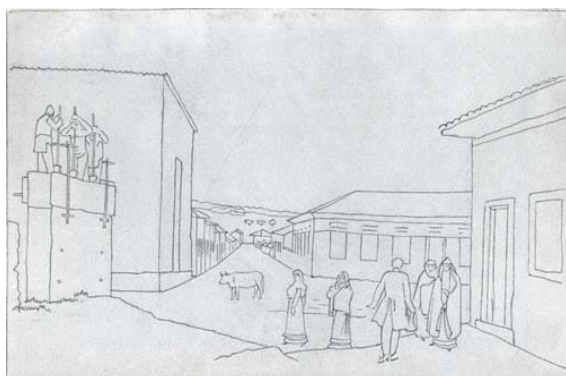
Os taapeiros construindo uma parede de taipa de pilão
